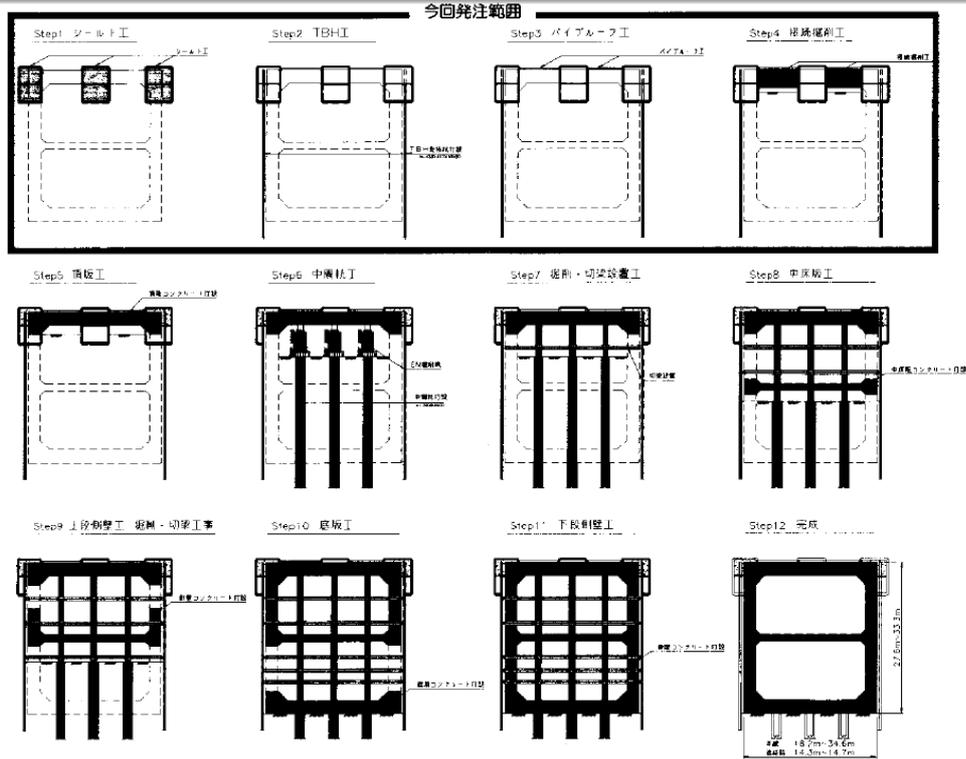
大橋 Junction 工程原設計施工示意圖
